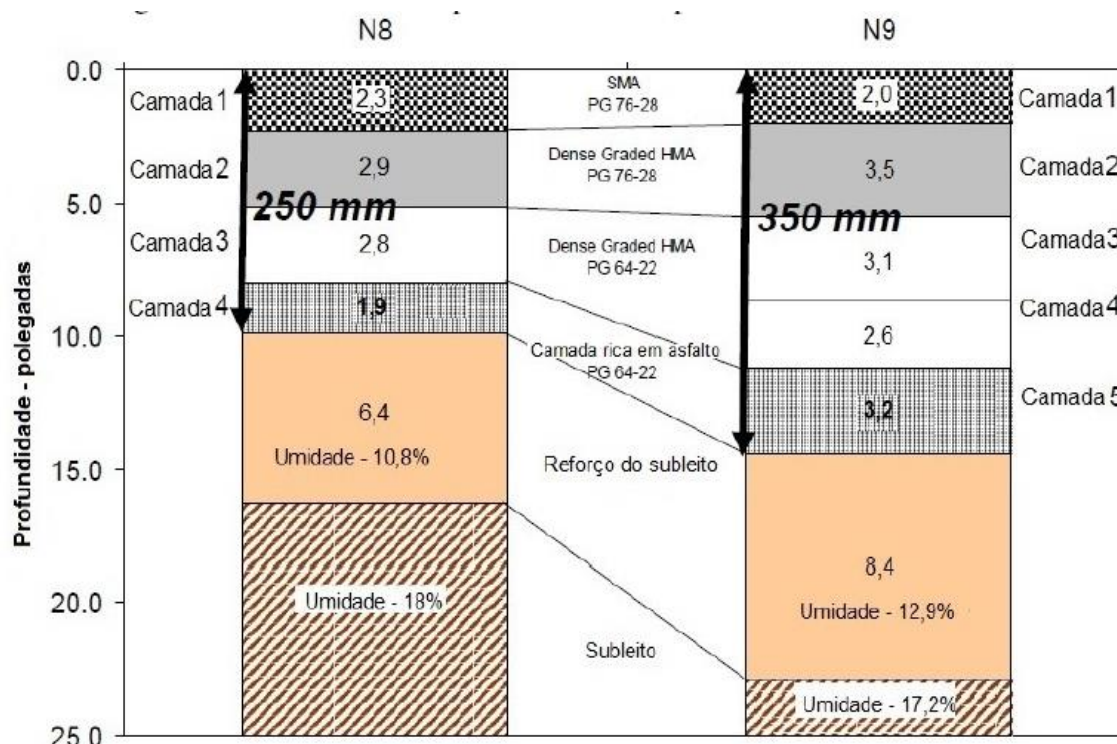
Estruturas dos pavimentos nas pistas de testes N8 e N9
